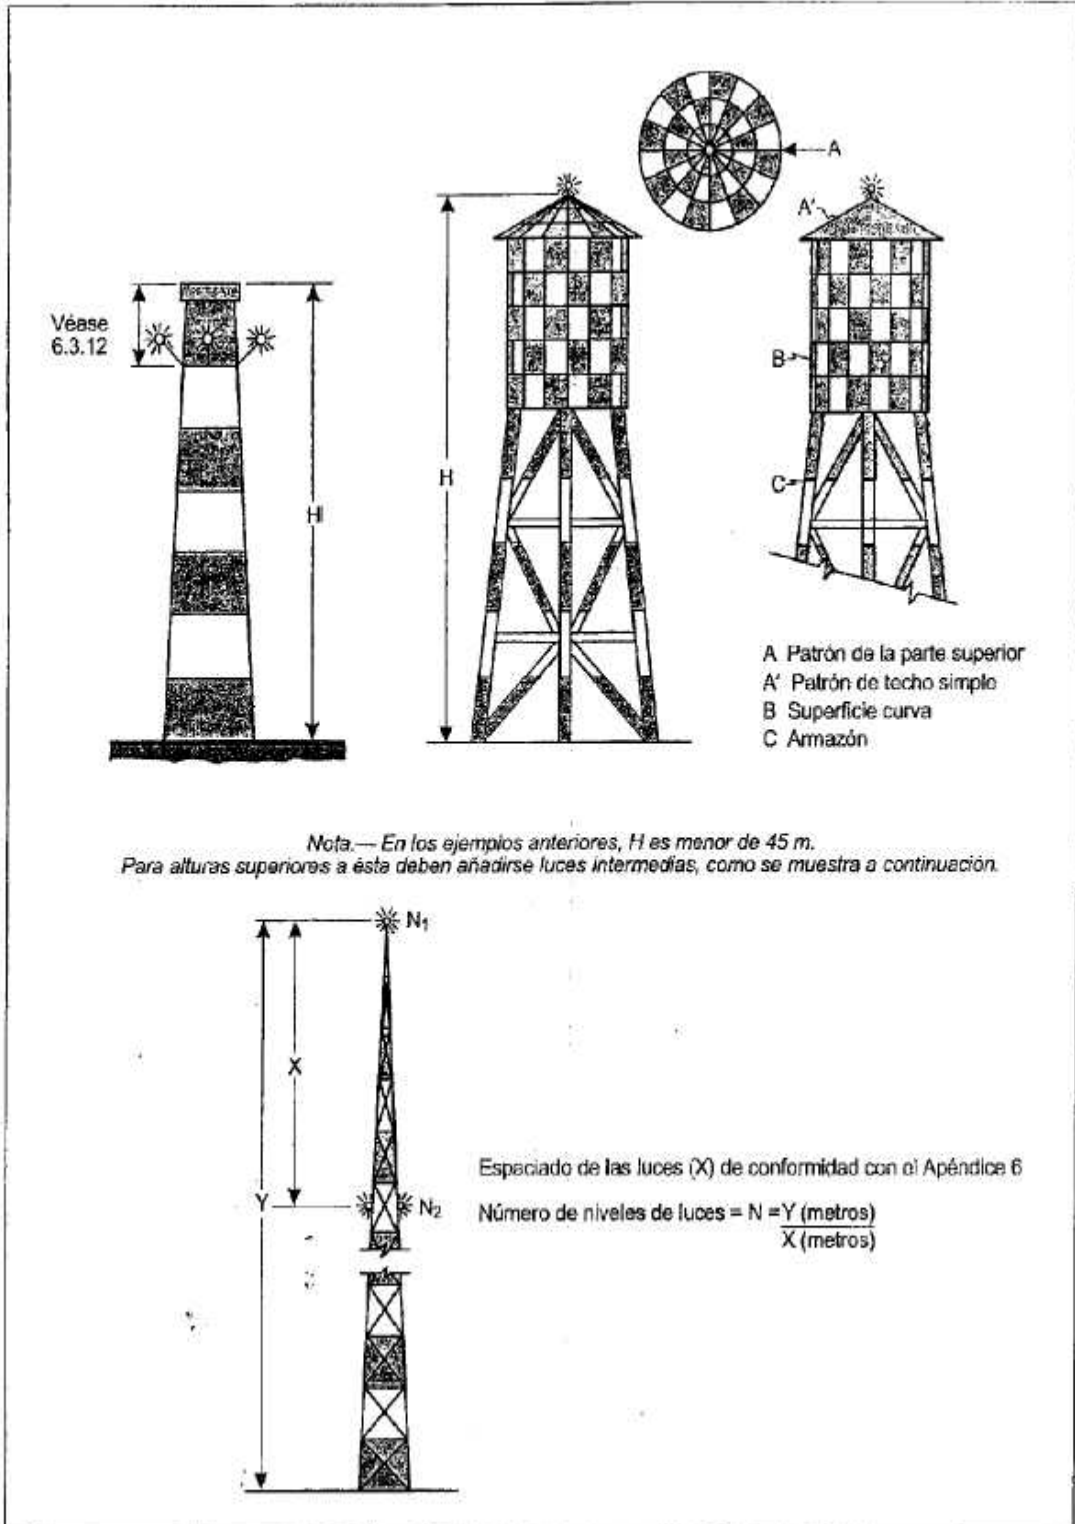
Ejemplos de señalamiento e iluminación de estructuras elevadas
